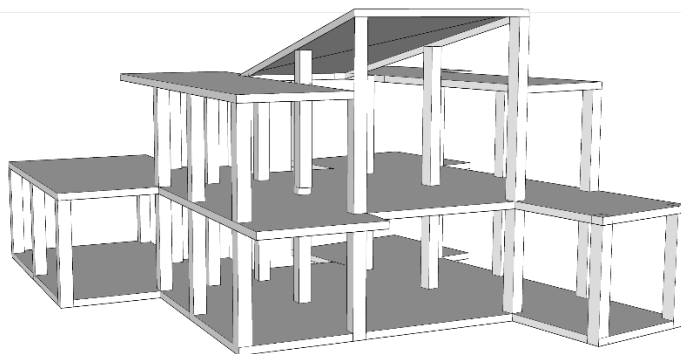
Les éléments structuraux des villas, Elaborée par : Auteurs, 2025
